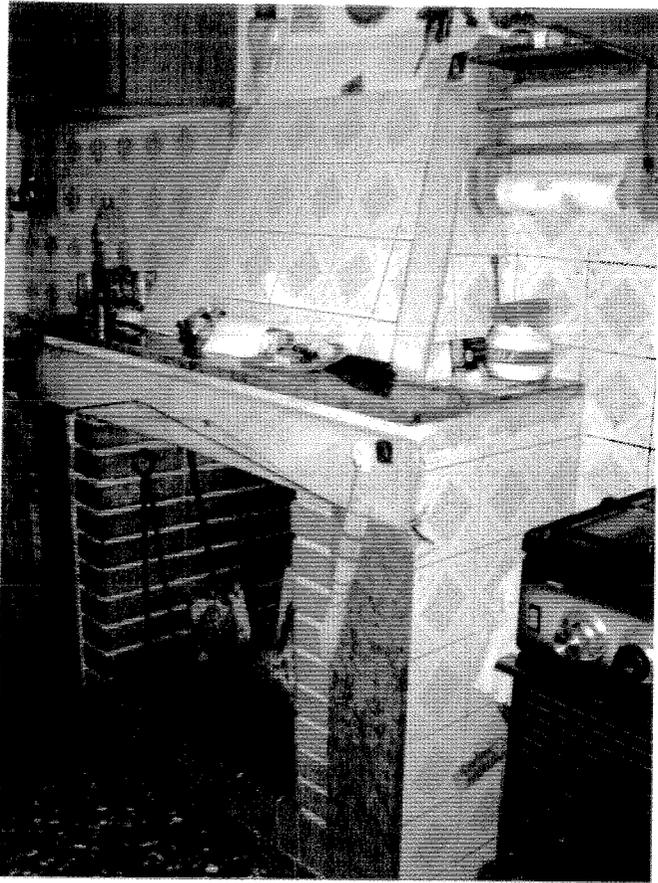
Interno appartamento P.T. - particolare cucina.
